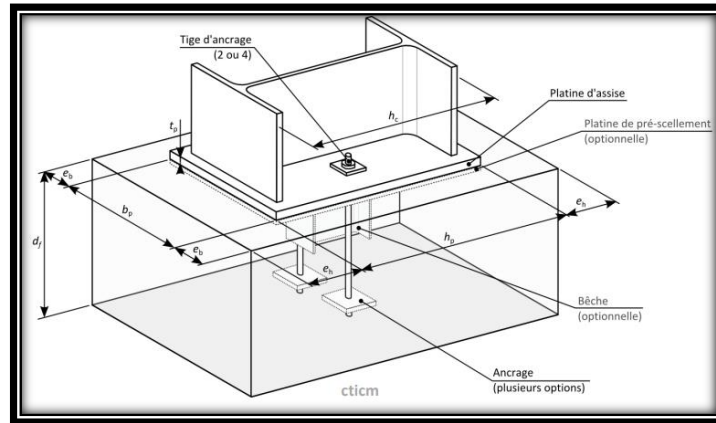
Conception d'un pied de poteau articulé. ; Source : JT COTITA RENFORCEMENT PARASISMIQUE STRUCTURES MÉTALLIQUES- P-O Martin / M Lukic JT CoTITA – 27/11/14
